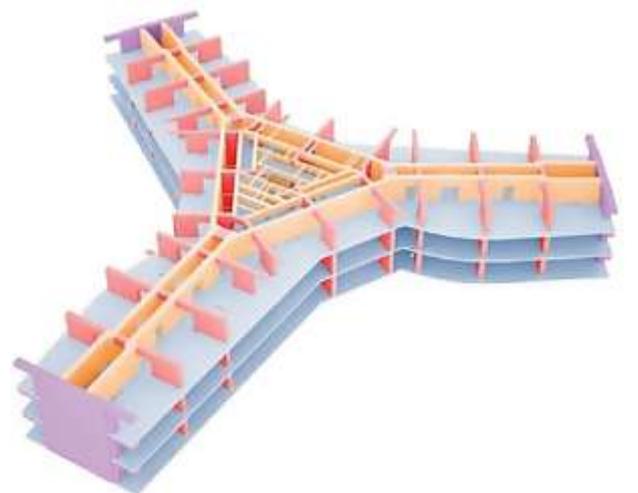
Схема расположения основных несущих элементов высотного здания «Кингдом Тауэр»
